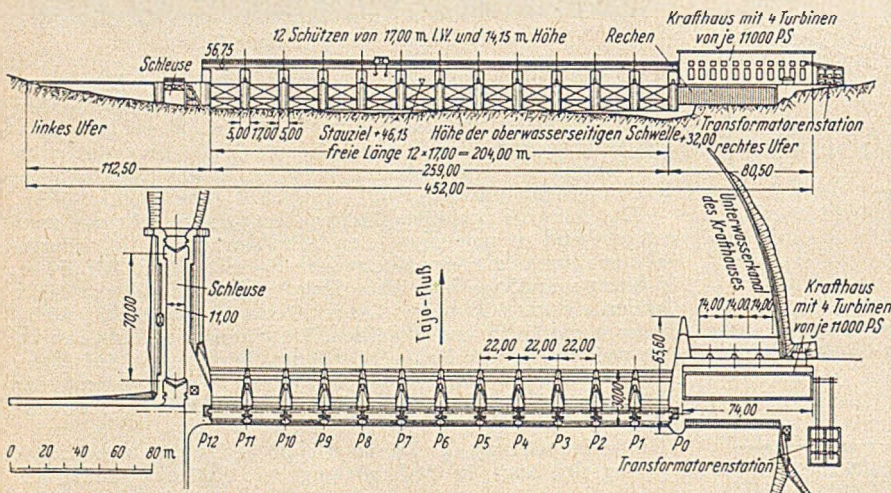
Wasserkraftanlage Belver. Grundriß und Aufriß der Gesamtanlage.
